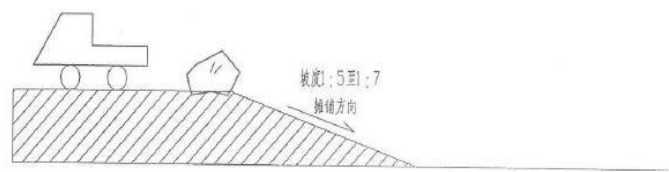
粉煤灰摊铺作业方法示意图（下推法）
